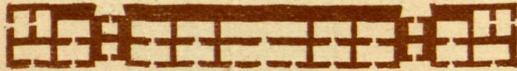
PLANTA DE LA CASA DEL GOBERNADOR,
